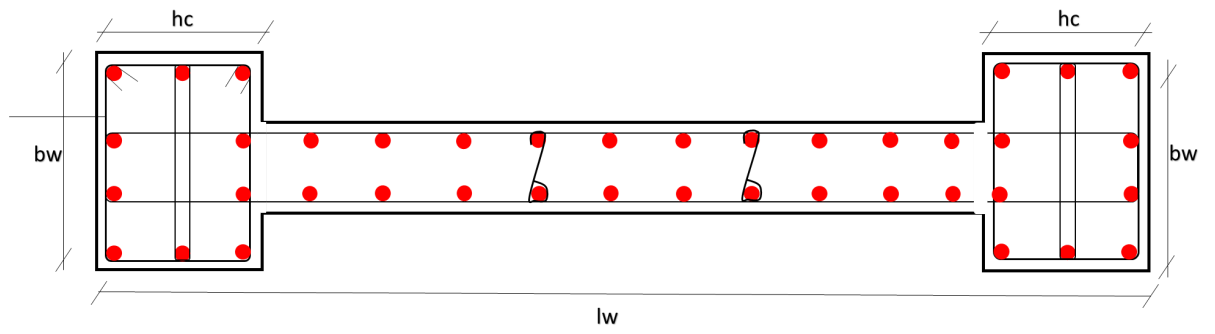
Schéma du ferrailage voile longitudinal complet V24
